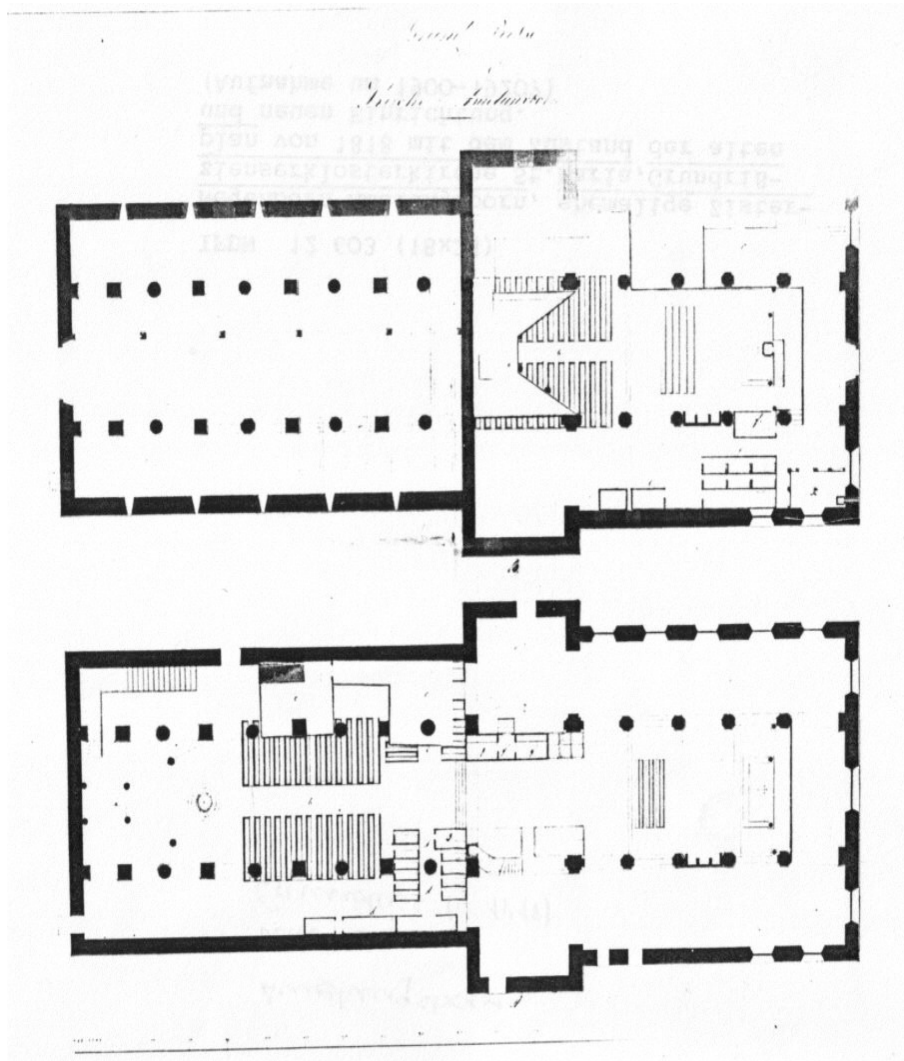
Umbauplan zur Stallkirche 1818, Nachlass Dr. Caspers
